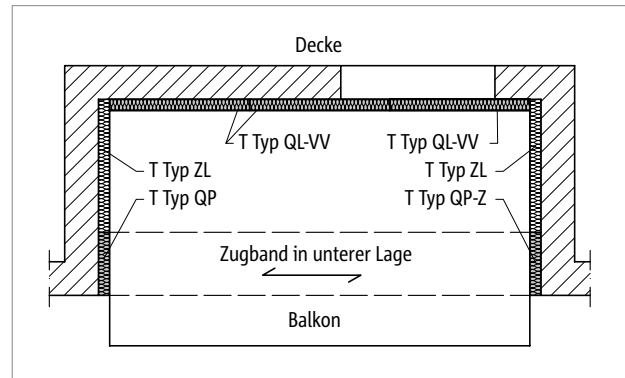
Schöck Isokorb® T Typ ZL, QL und QP: Dreiseitig gelagerte Loggia mit Zugband
